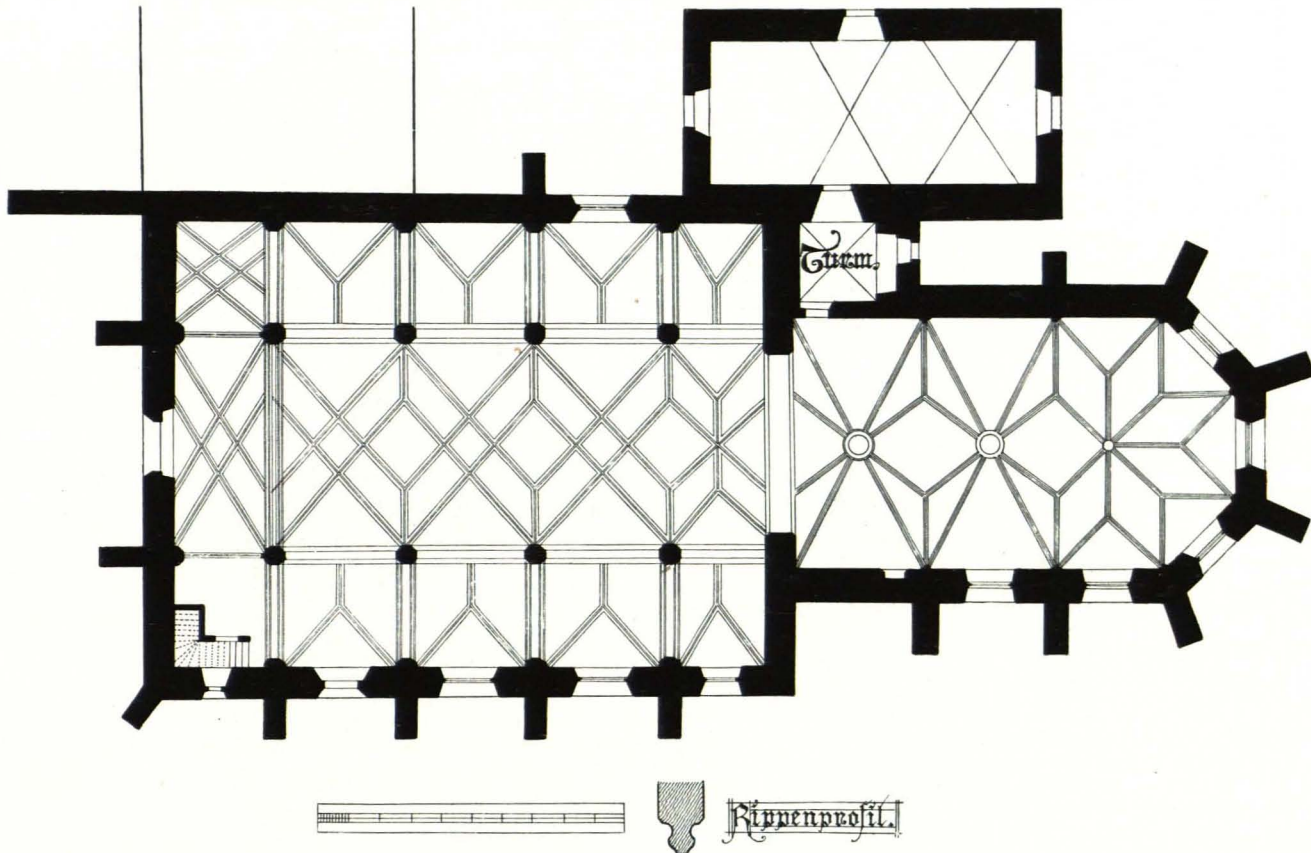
Schönbach, Pfarrkirche, Grundriß 1 : 250 (S. 211)
